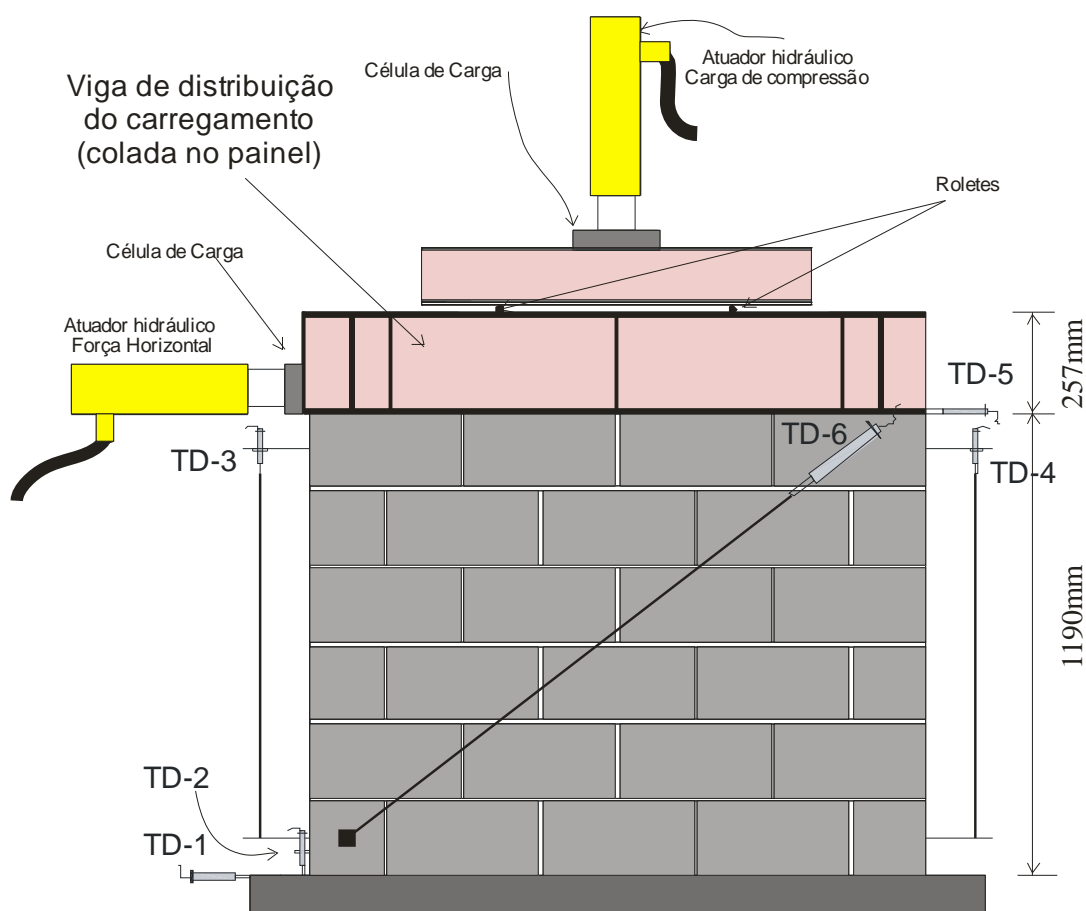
Instrumentação usada nos ensaios dos painéis de contraventamento.
